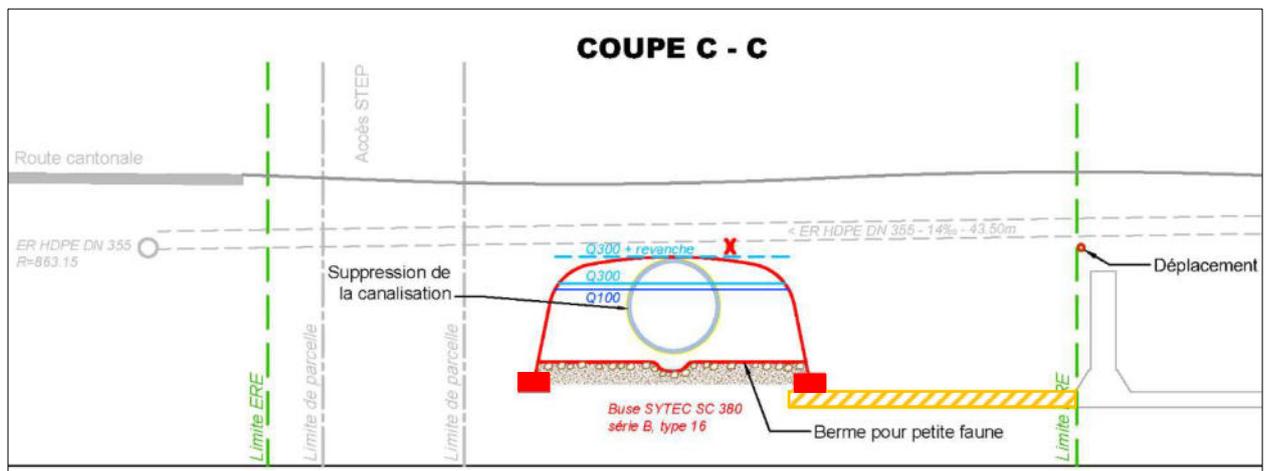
Fondations en béton de la buse (en rouge) et ancienne semelle démolie (en orange)
